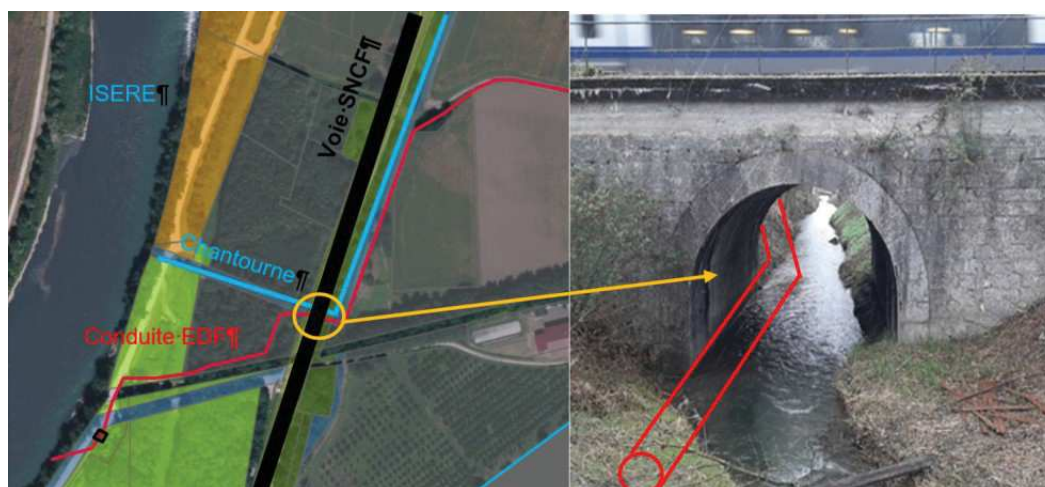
Passage de la conduite sous l'ouvrage SNCF existant
